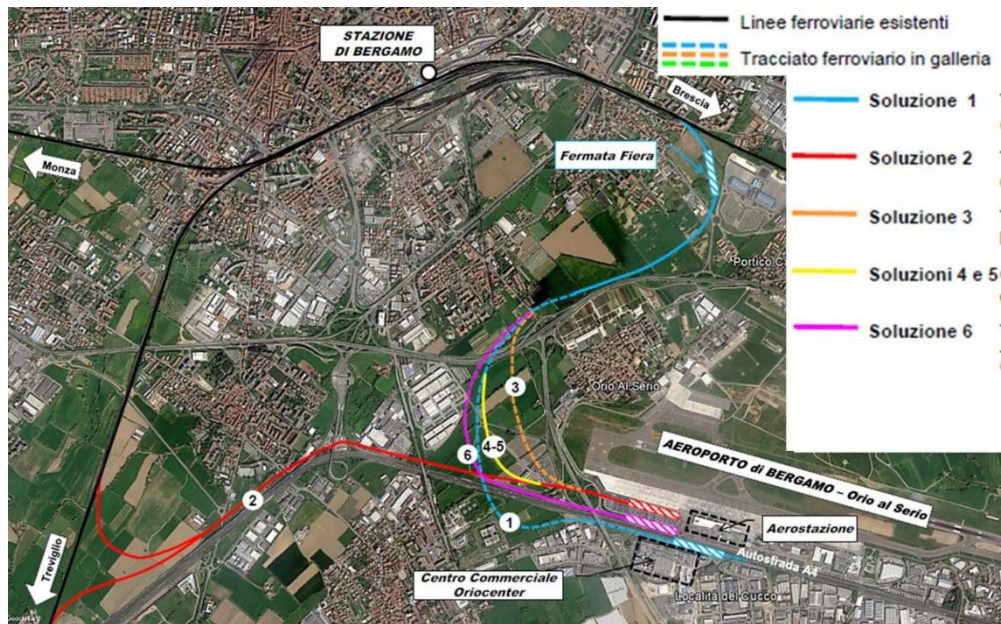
Collegamento con Orio al Serio: quadro di insieme delle soluzioni progettuali
